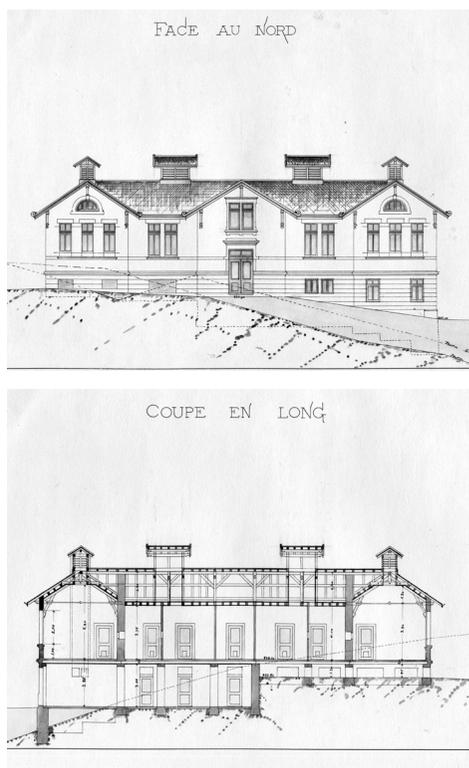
Montreux, lazaret de La Foge, élévation de la façade nord et coupe longitudinale, Louis Villard architecte, 1896 (AM).
